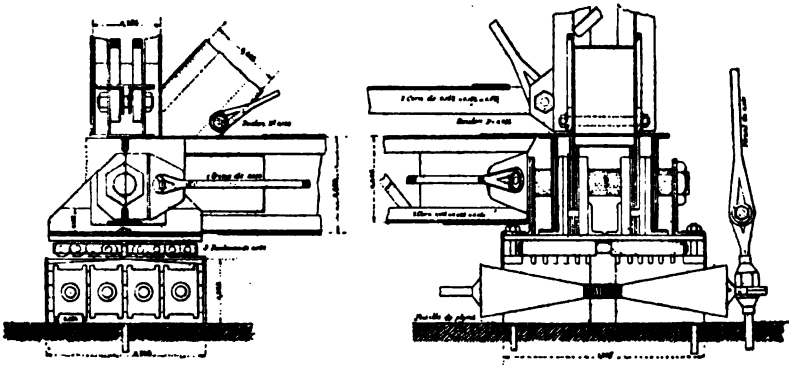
Palier ajustable du Pont de Lachine.
